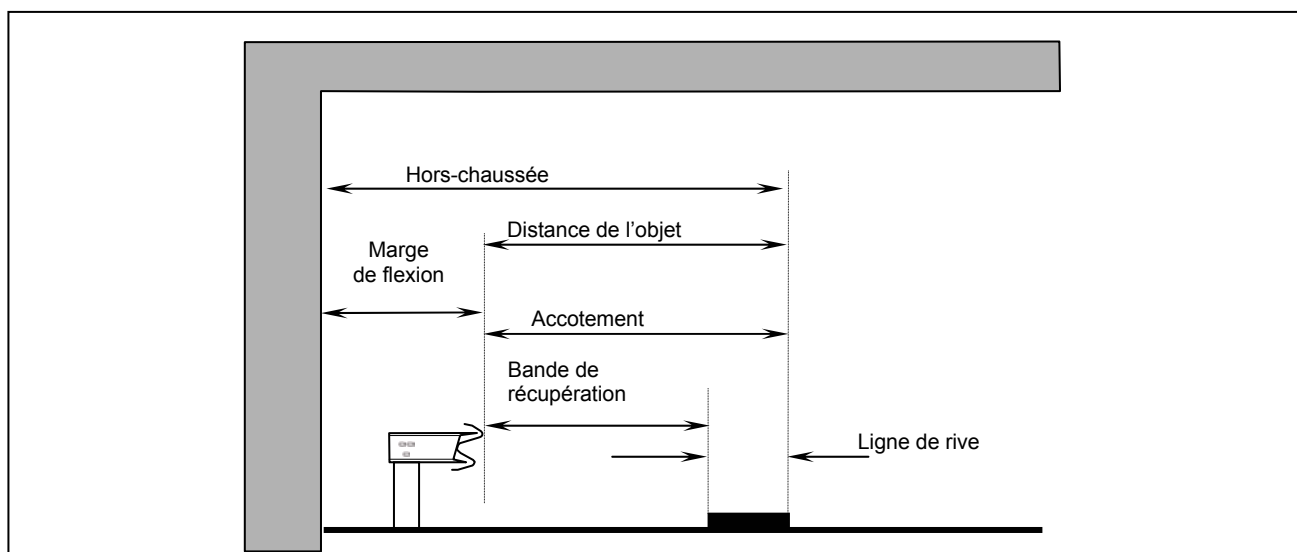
Éléments et fonctions d'une zone hors-chaussée avec rampes de protection métalliques
